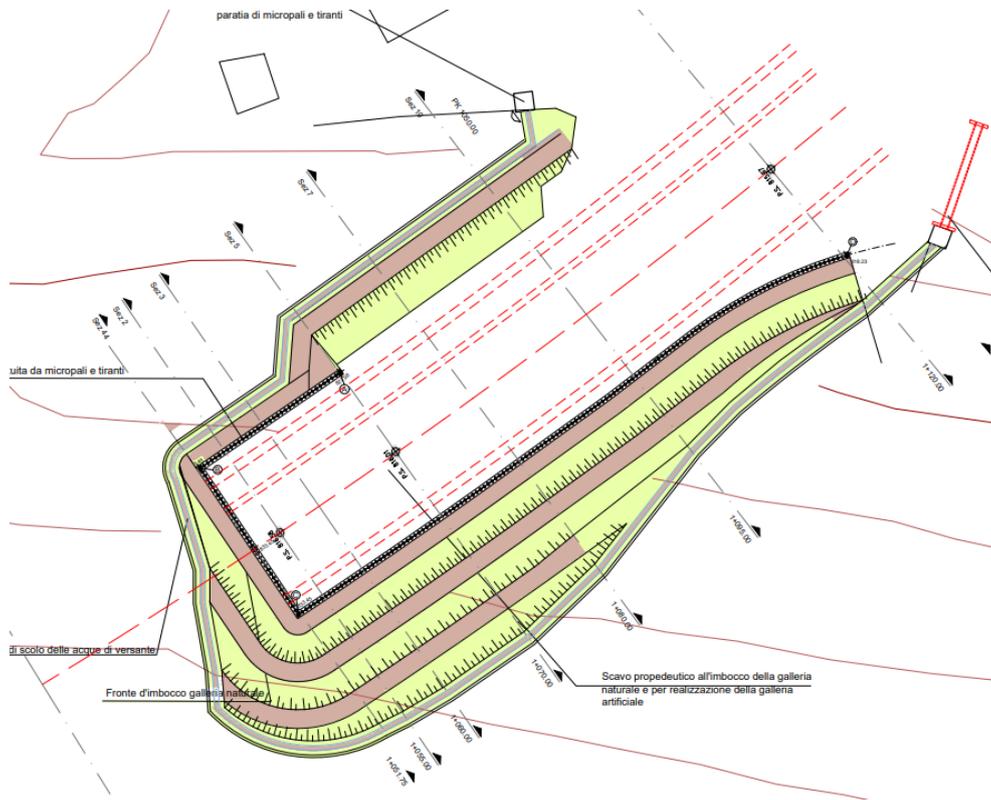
Planimetria imbocco Est Progetto Definitivo
